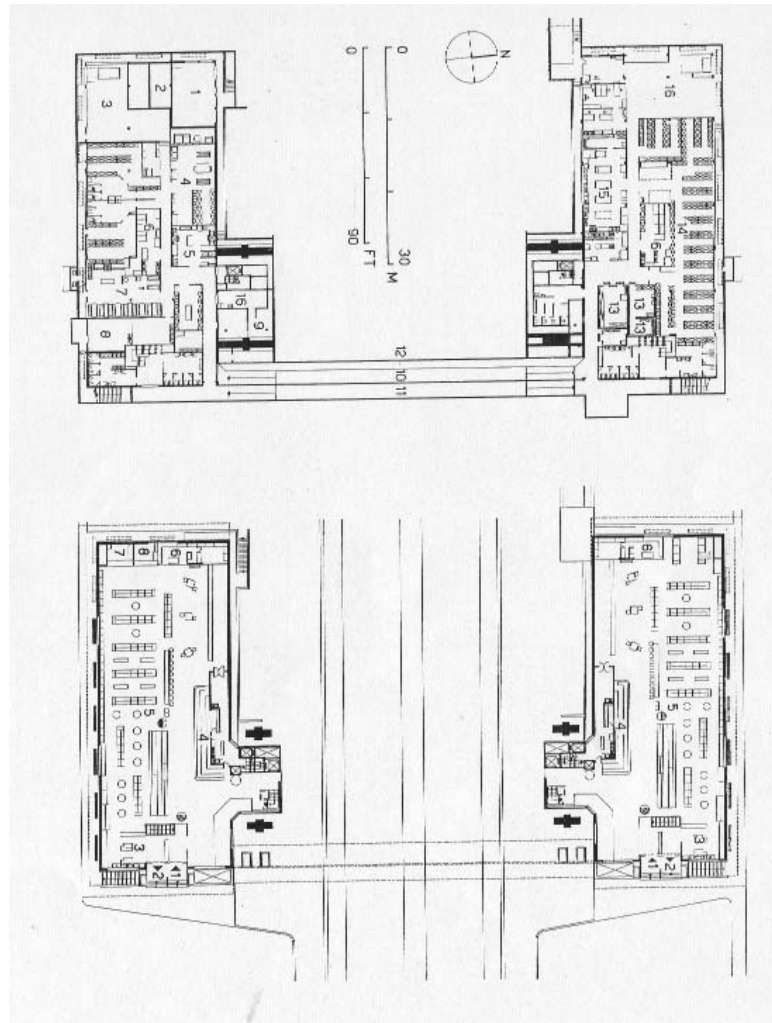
Pianta del piano interato (in alto) e del piano terra (in basso)
